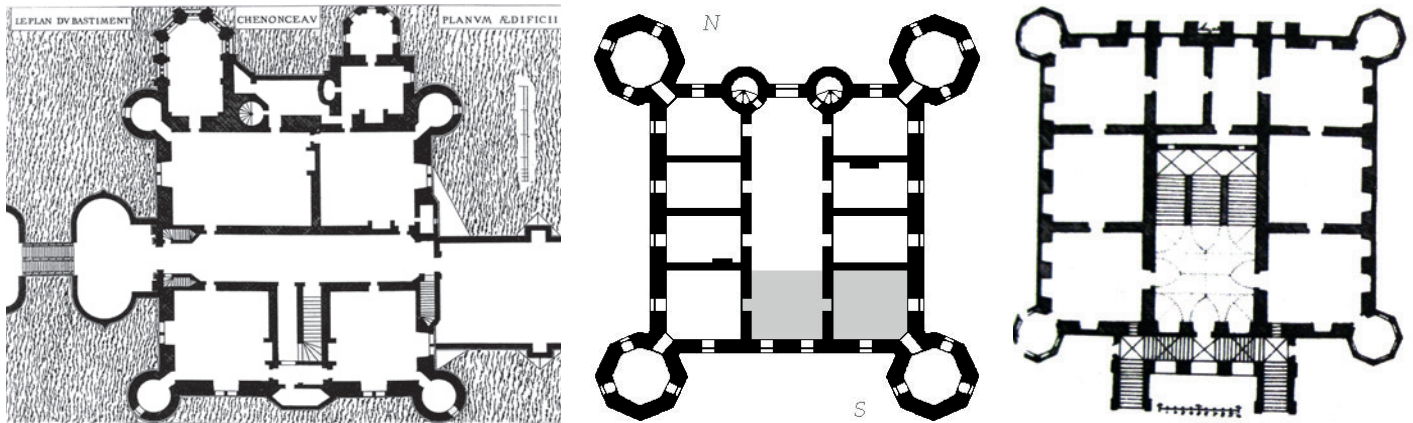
Schloss Chenonceau, Grundriss (aus: Jacques I. Androuet du Cerceau/Jean-Pierre Babelon, *Châteaux de France au siècle de la renaissance*, Paris 1989, S. 119).
